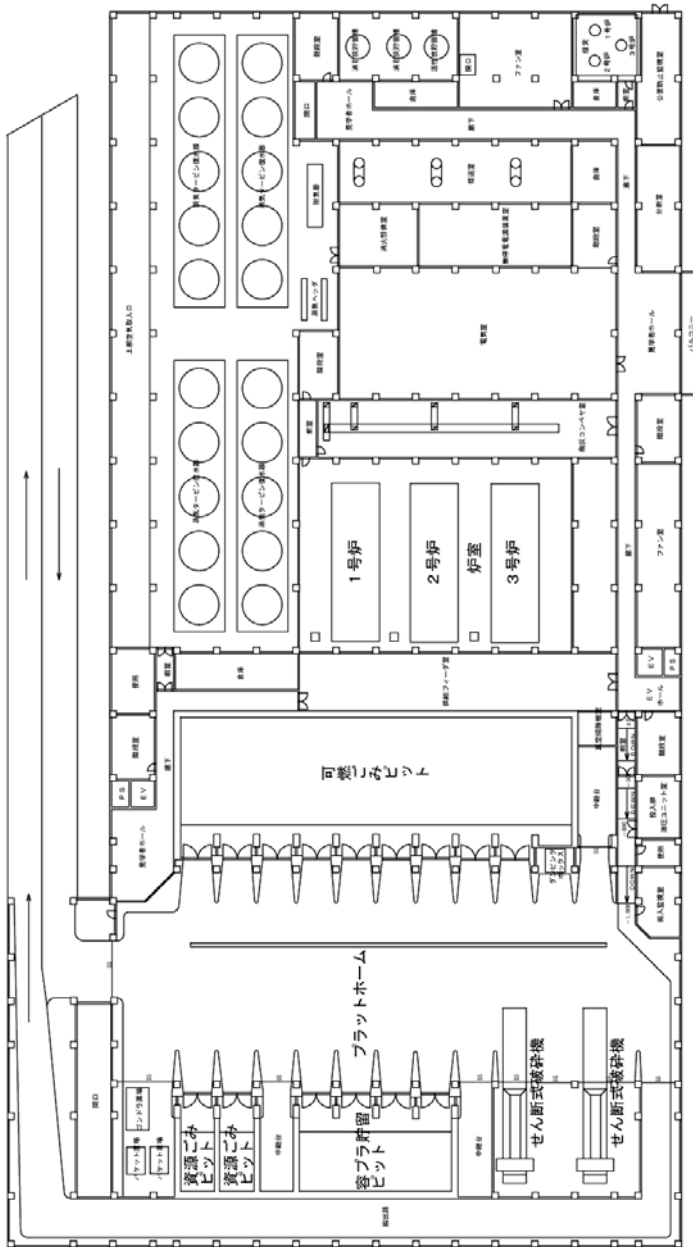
焼却施設（クリーンセンター工場棟）平面図（3階部分）
